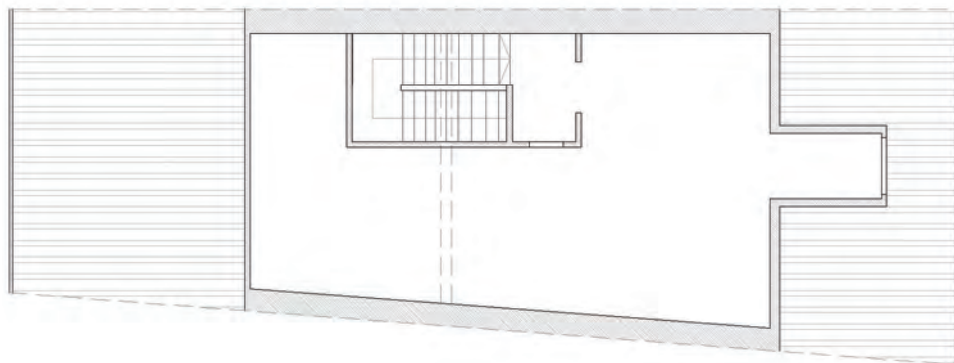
12. PLANTA BAJOCUBIERTA
